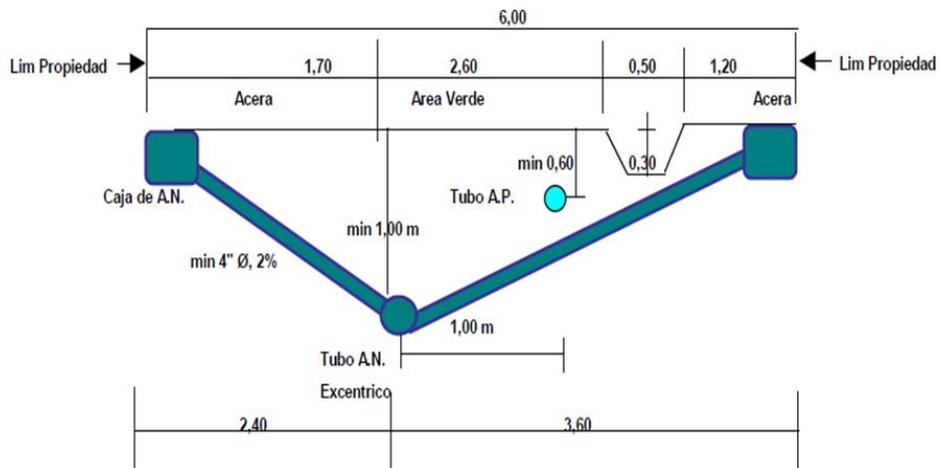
Perfil de la sección típica de las calles peatonales con tubería.
